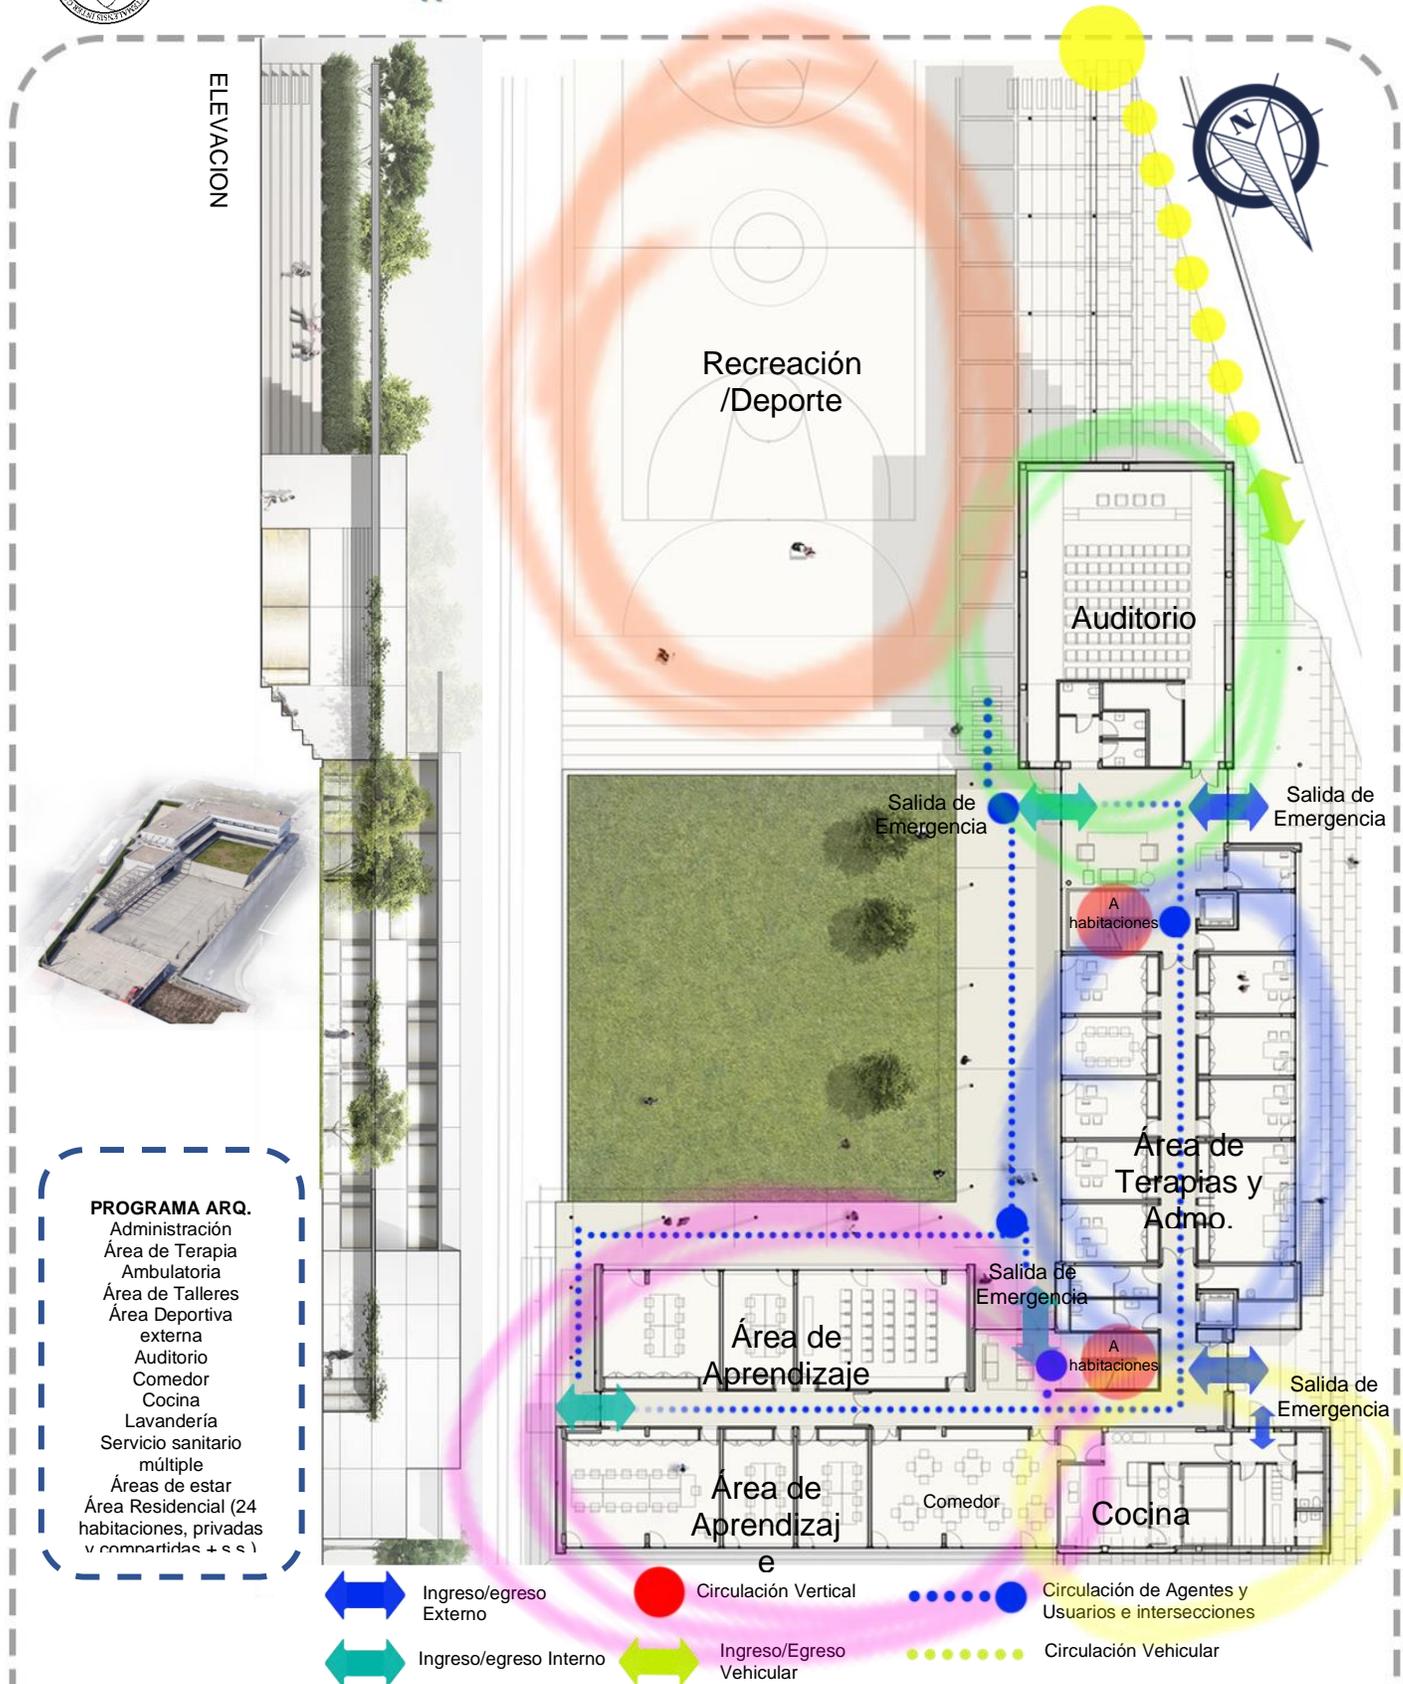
Análisis sobre la planta del proyecto: Fundación Monde Do Gozo Proxecto Home, Elaboración Propia.
